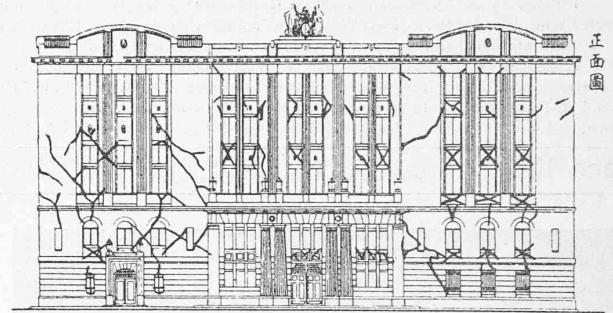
u. 4. Grundriss und Fassade 1 : 600 eines Gebäudes in Japan mit Eintragung der Risse infolge des Bebens vom September 1923.
